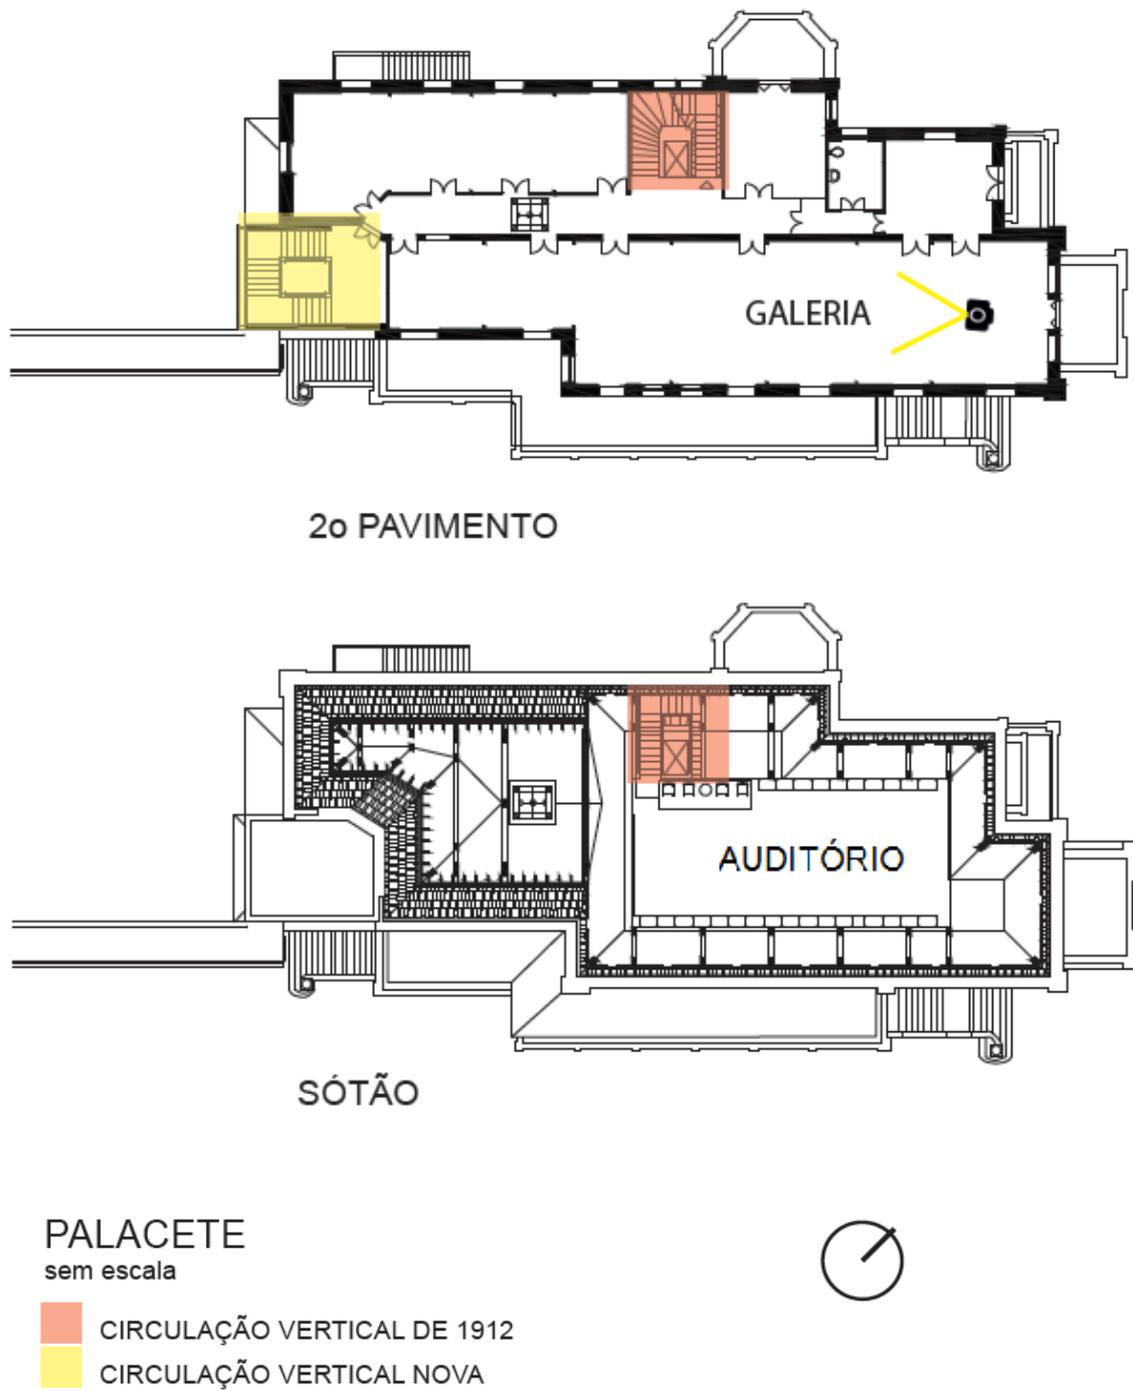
Plantas do Segundo Pavimento e Sótão do *Palacete das Artes* (BRASIL ARQUITETURA, 2015)
